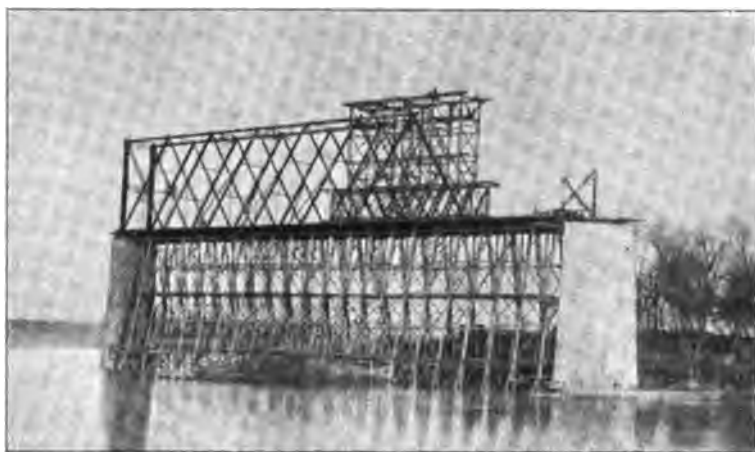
Montage, sur échafaudages, de la travée contrepoids du pont de Kentucky & Indiana (Union Bridge Co).
